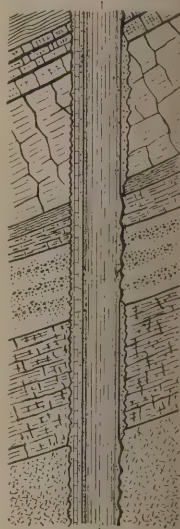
Vertikalquerschnitt durch einen Steigschacht mit richtig angelegter Drainage.
